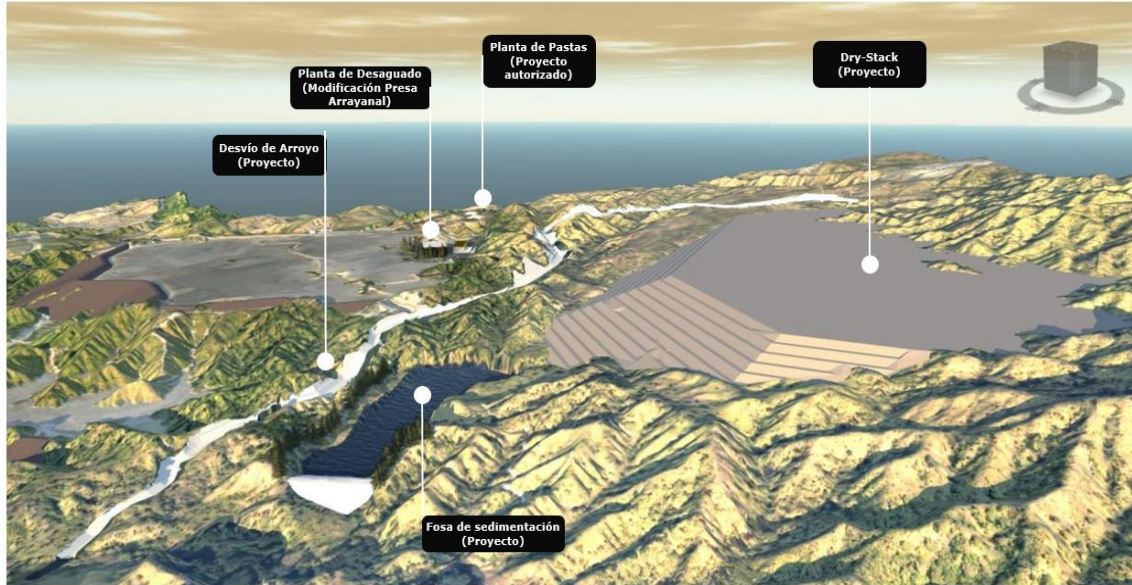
Vista 3D (Render) del proyecto y las obras aledañas existentes.
